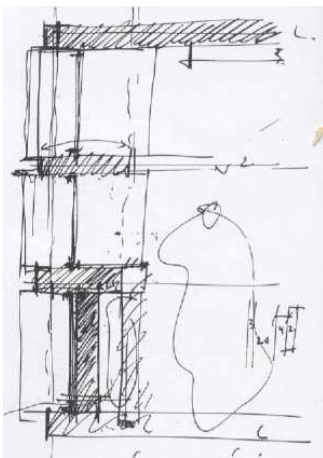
Eduardo Souto de Moura, Torre Burgo (1991/95 – Fase 1; 2003/04 - Fase 2; 2007 - Construção)
